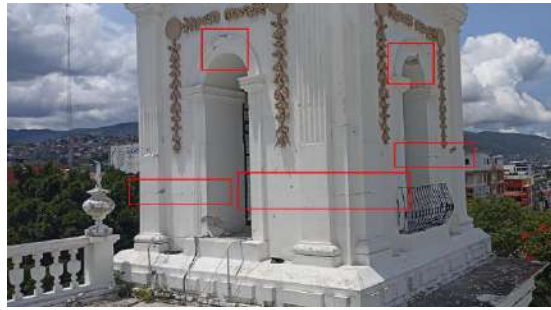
Grietas en base de la torre – campanario norte. Fuente propia.
